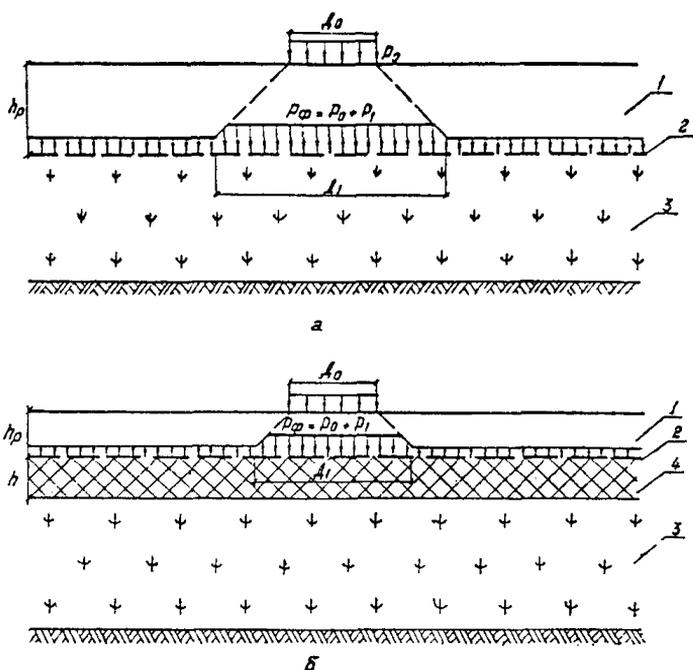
Расчетная схема для определения толщины насыпного слоя: а — конструкция по типу 1; б — конструкция по типу 2; 1 — насыпной грунт; 2 — текстильная прослойка; 3 — слабое основание; 4 — насыпной торф
